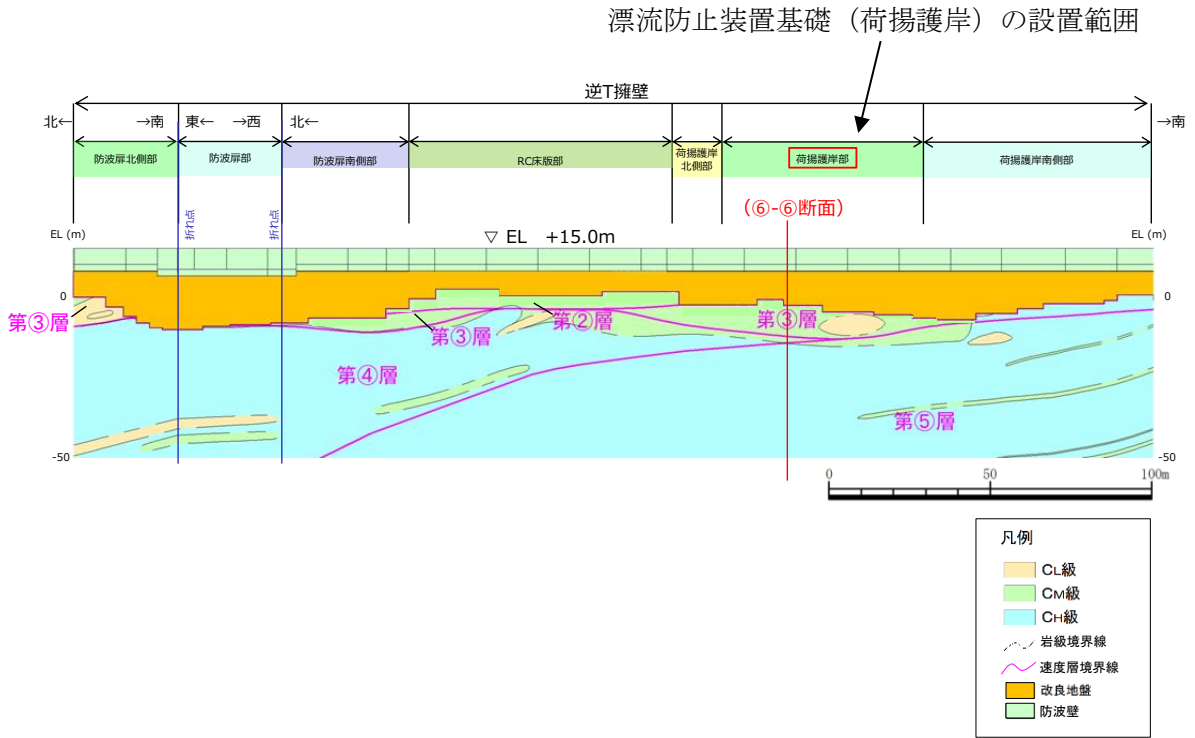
防波壁（逆T擁壁）の地質縦断面図
